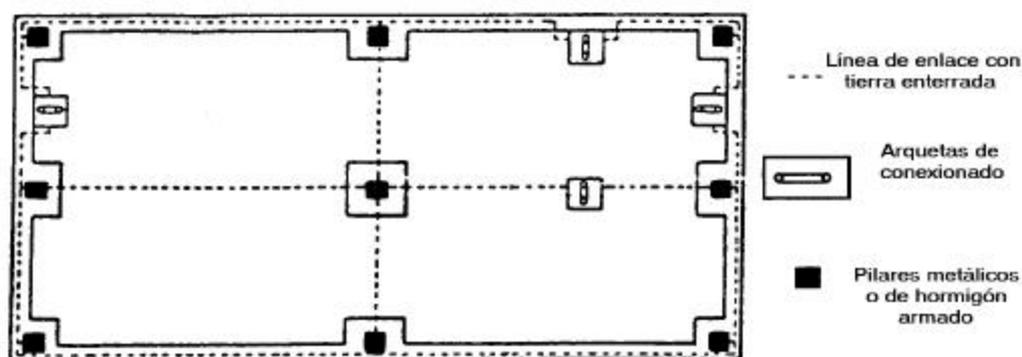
Sección de una planta de un edificio con su correspondiente puesta a tierra
